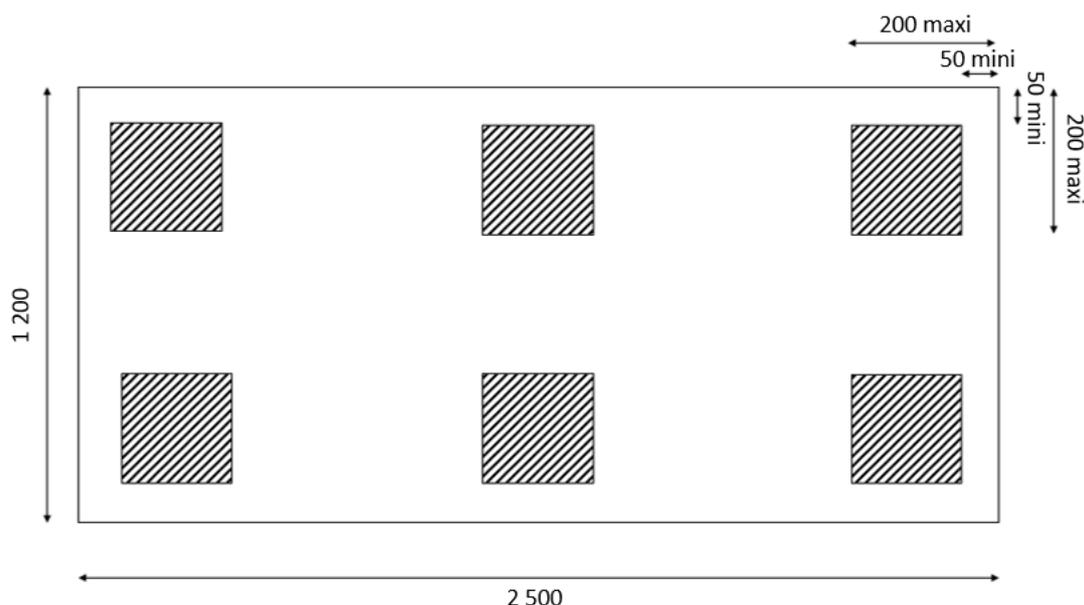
Implantation des fixations sur les panneaux Knauf SteelThane
